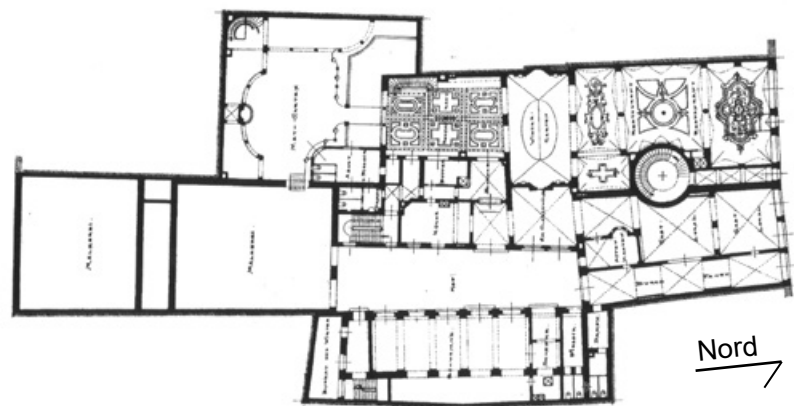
Grundriss Erdgeschoss (Habel et.al 2009, S. 694).
